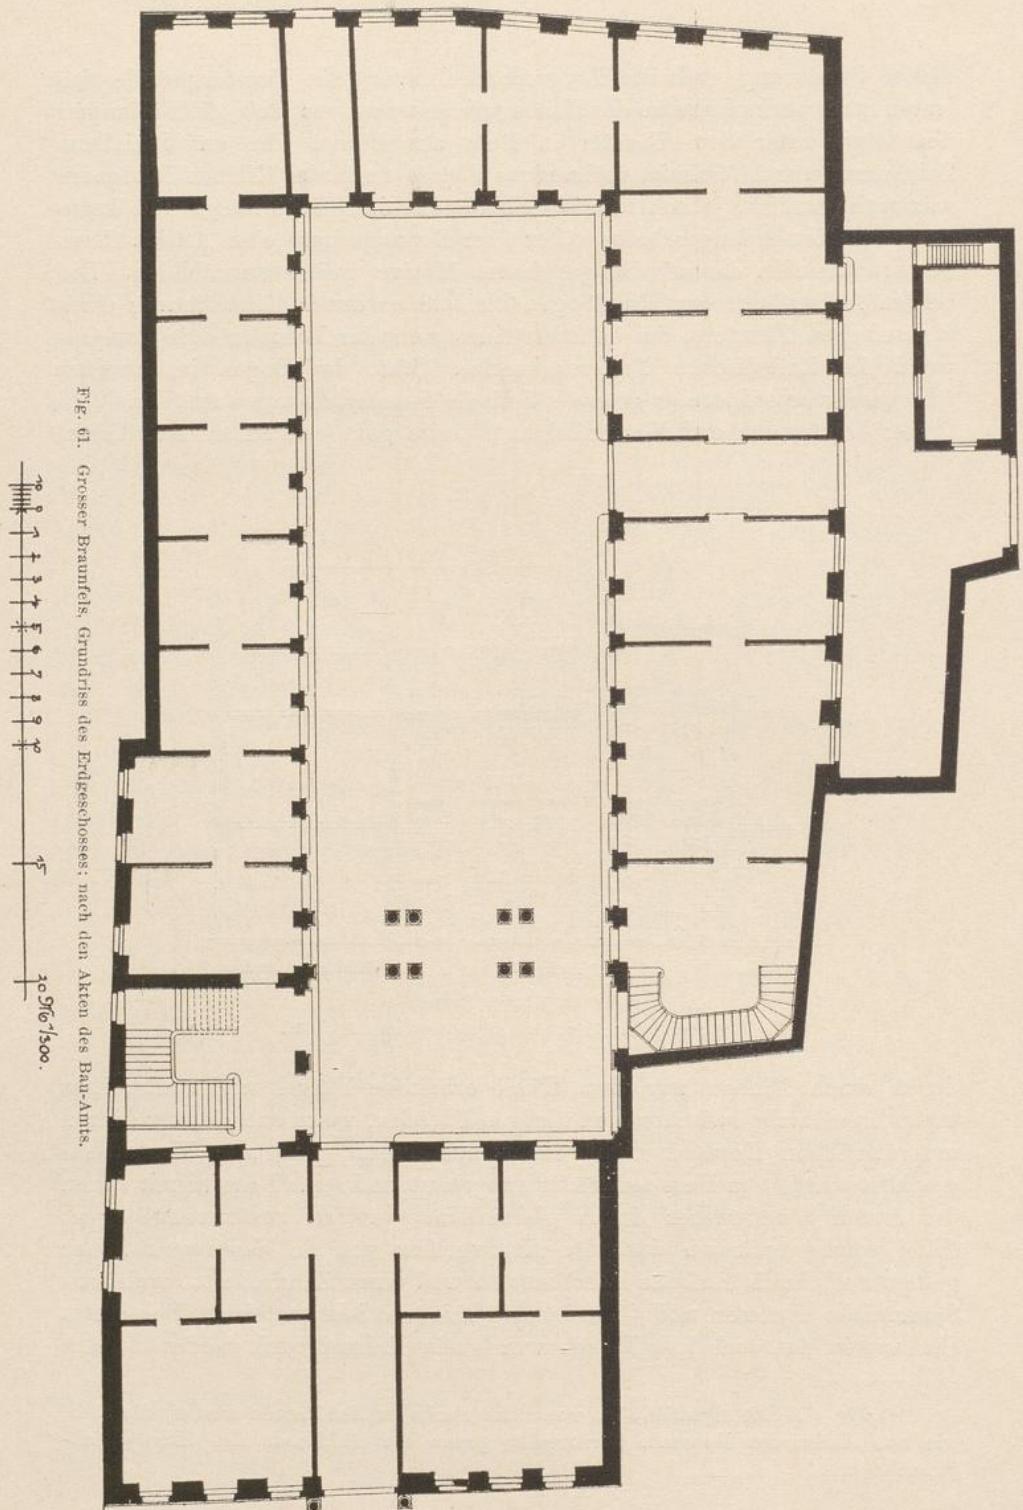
Grosser Braunfels, Grundriss des Erdgeschosses; nach den Akten des Bau-Amts,
